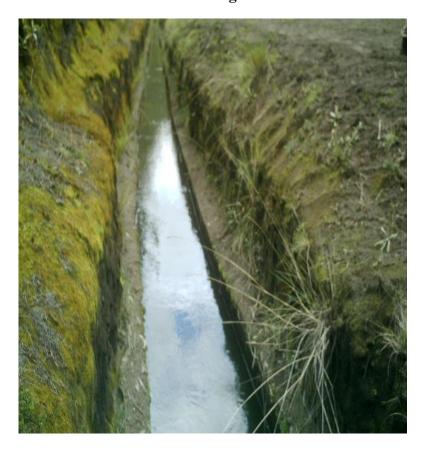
Conducción Secundaria Guargualla- Ceceles..
